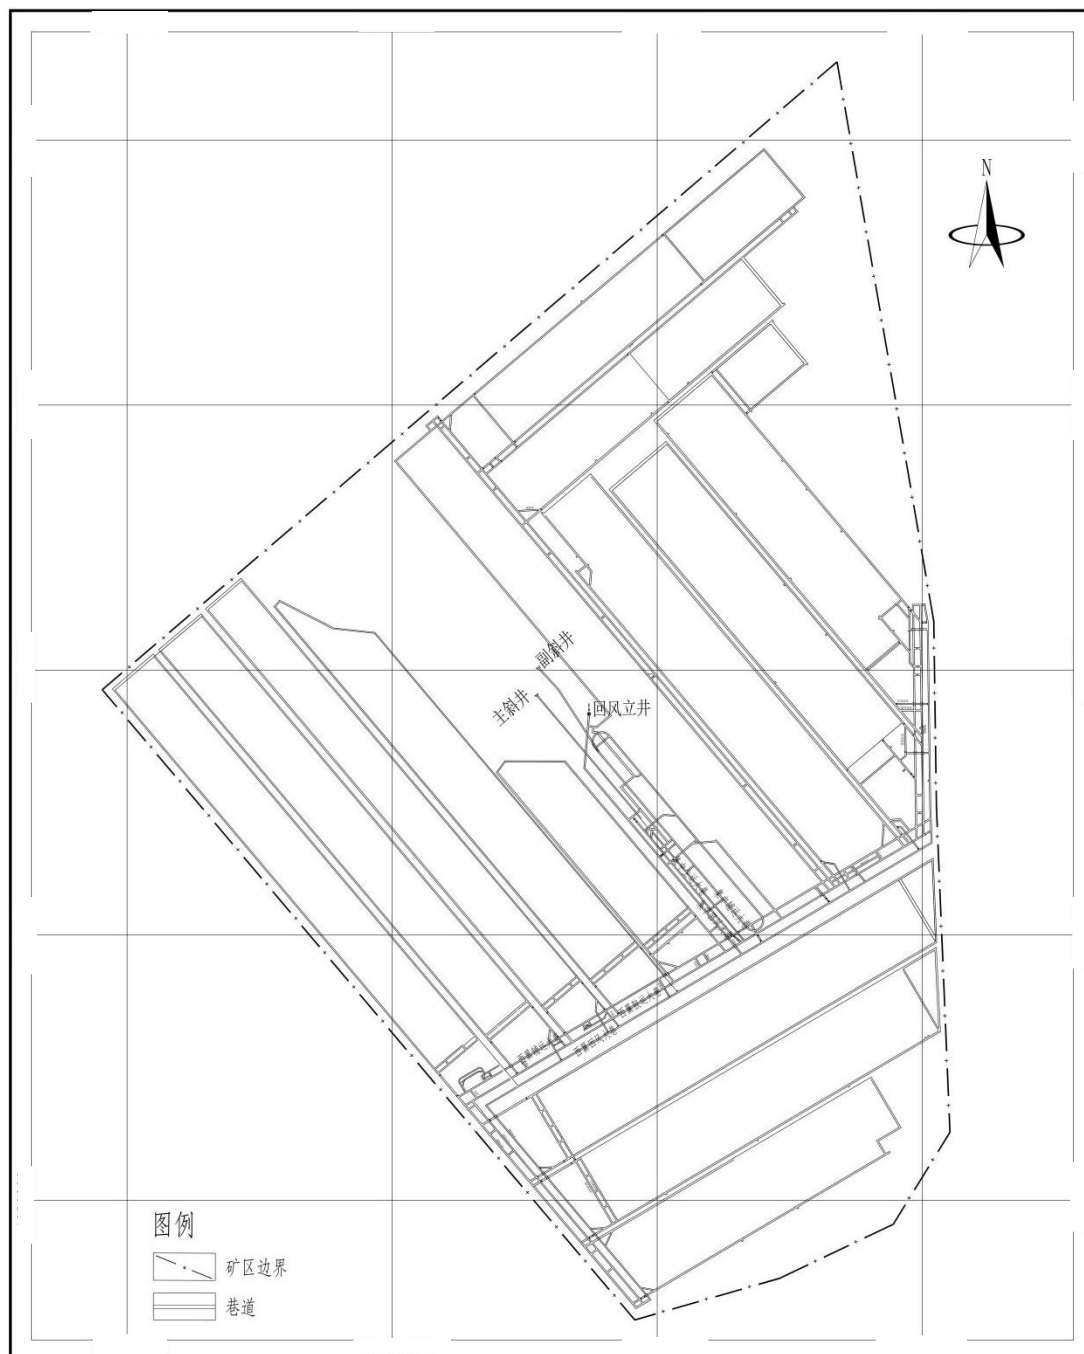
煤层开拓大巷平面布置图（一水平）
